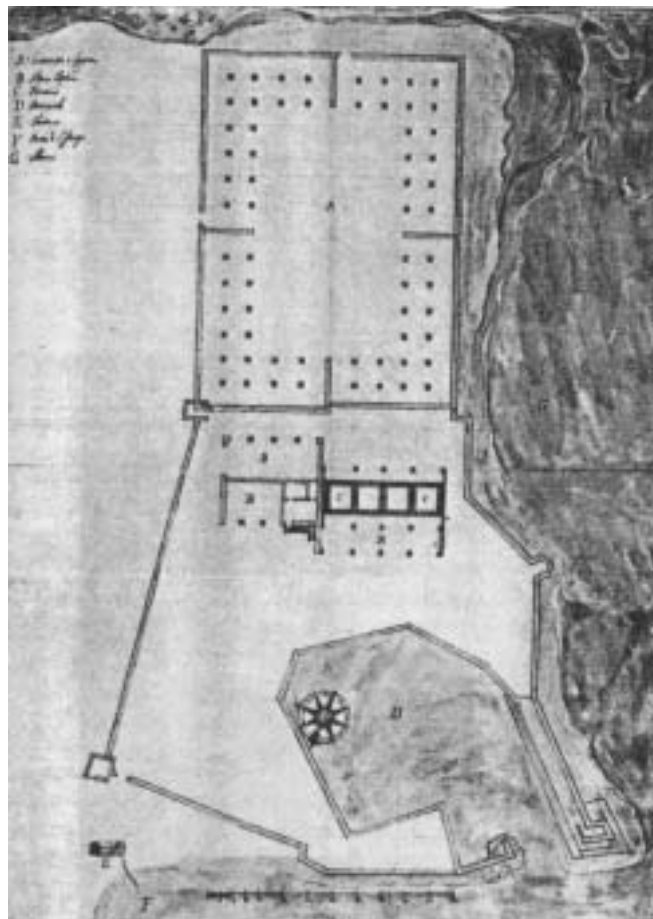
Lazareto de San Rocco (Livorno), planta (ASF, Mediceo, 1828)
